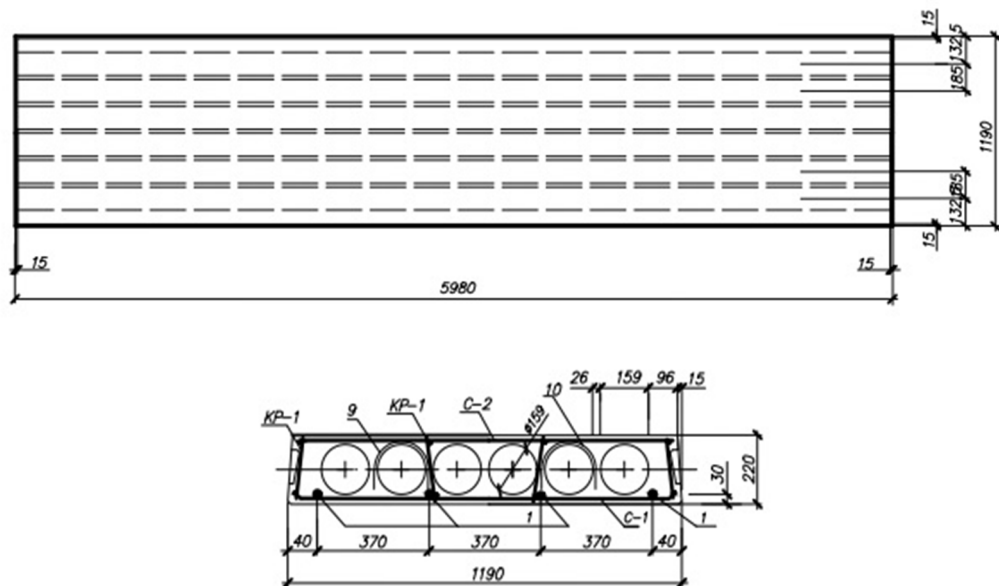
План та переріз вибраної залізобетонної плити перекриття з технічними розмірами
